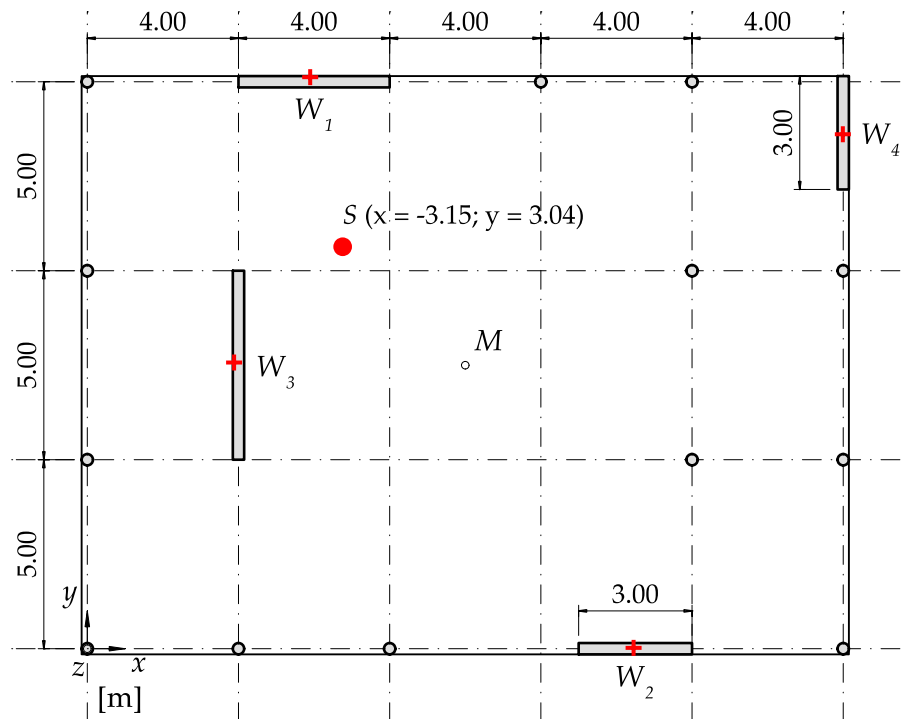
Grundriss mit Schubmittelpunkt
